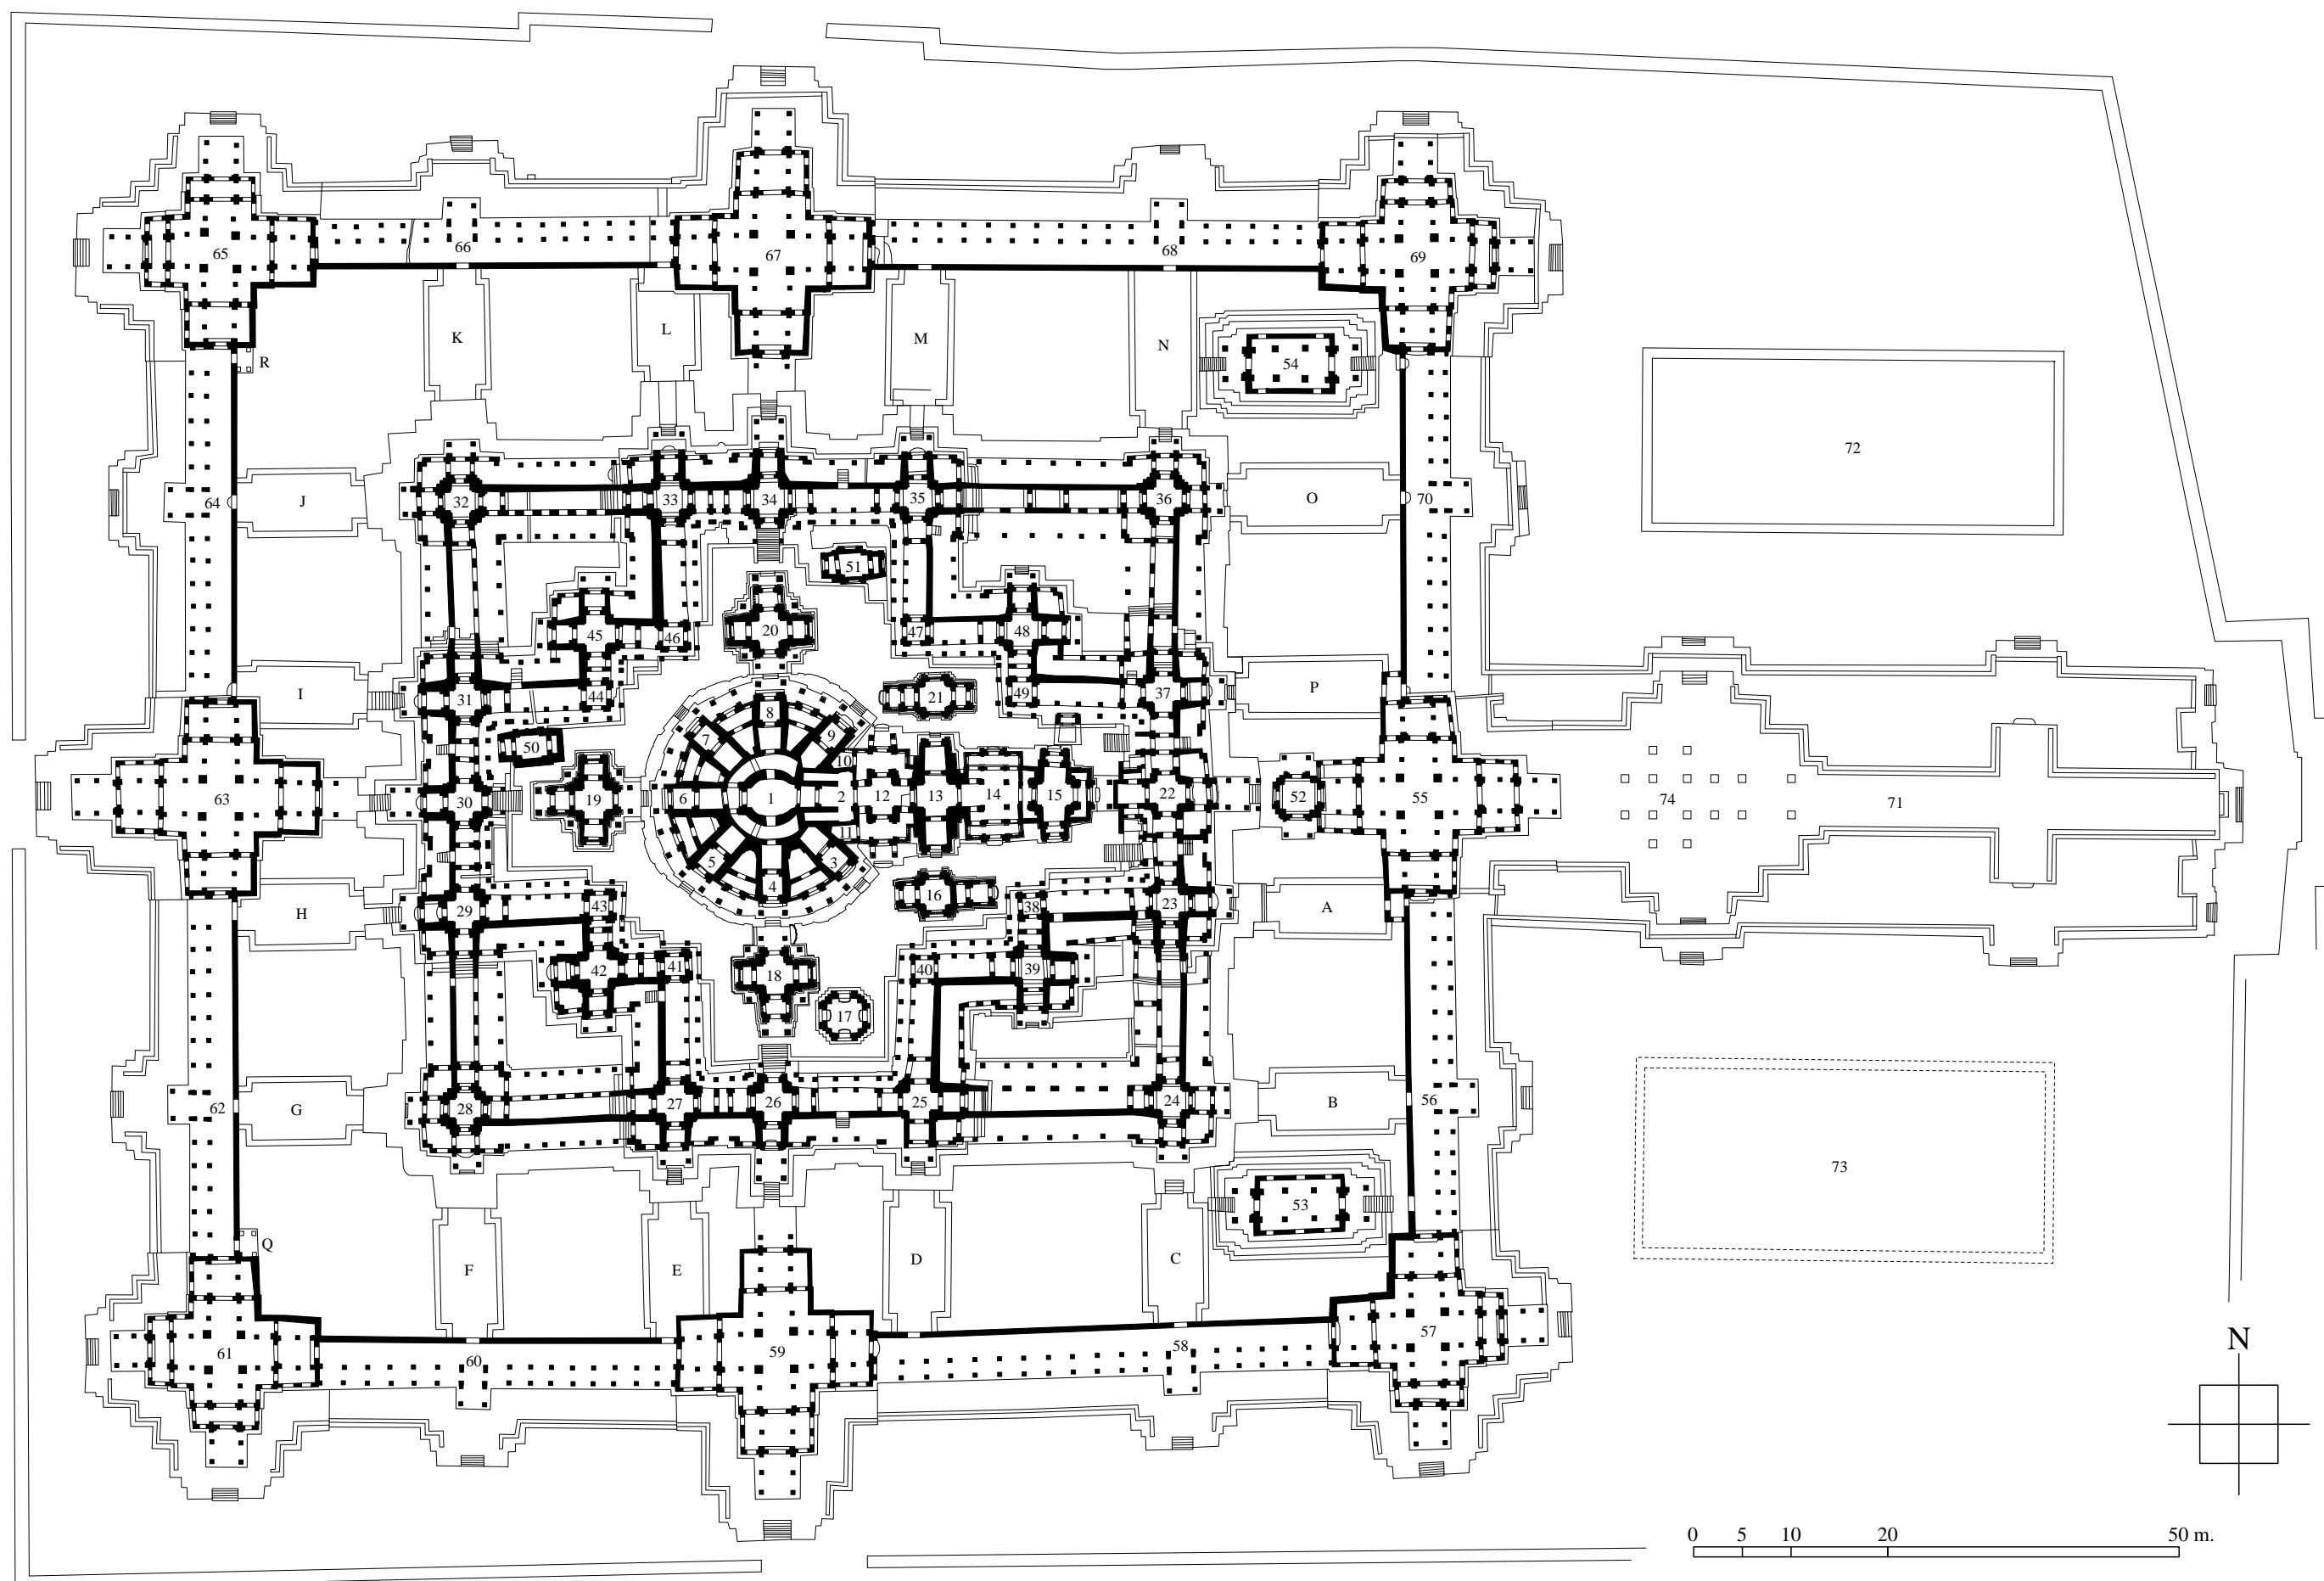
Plan d'ensemble du Bayon
